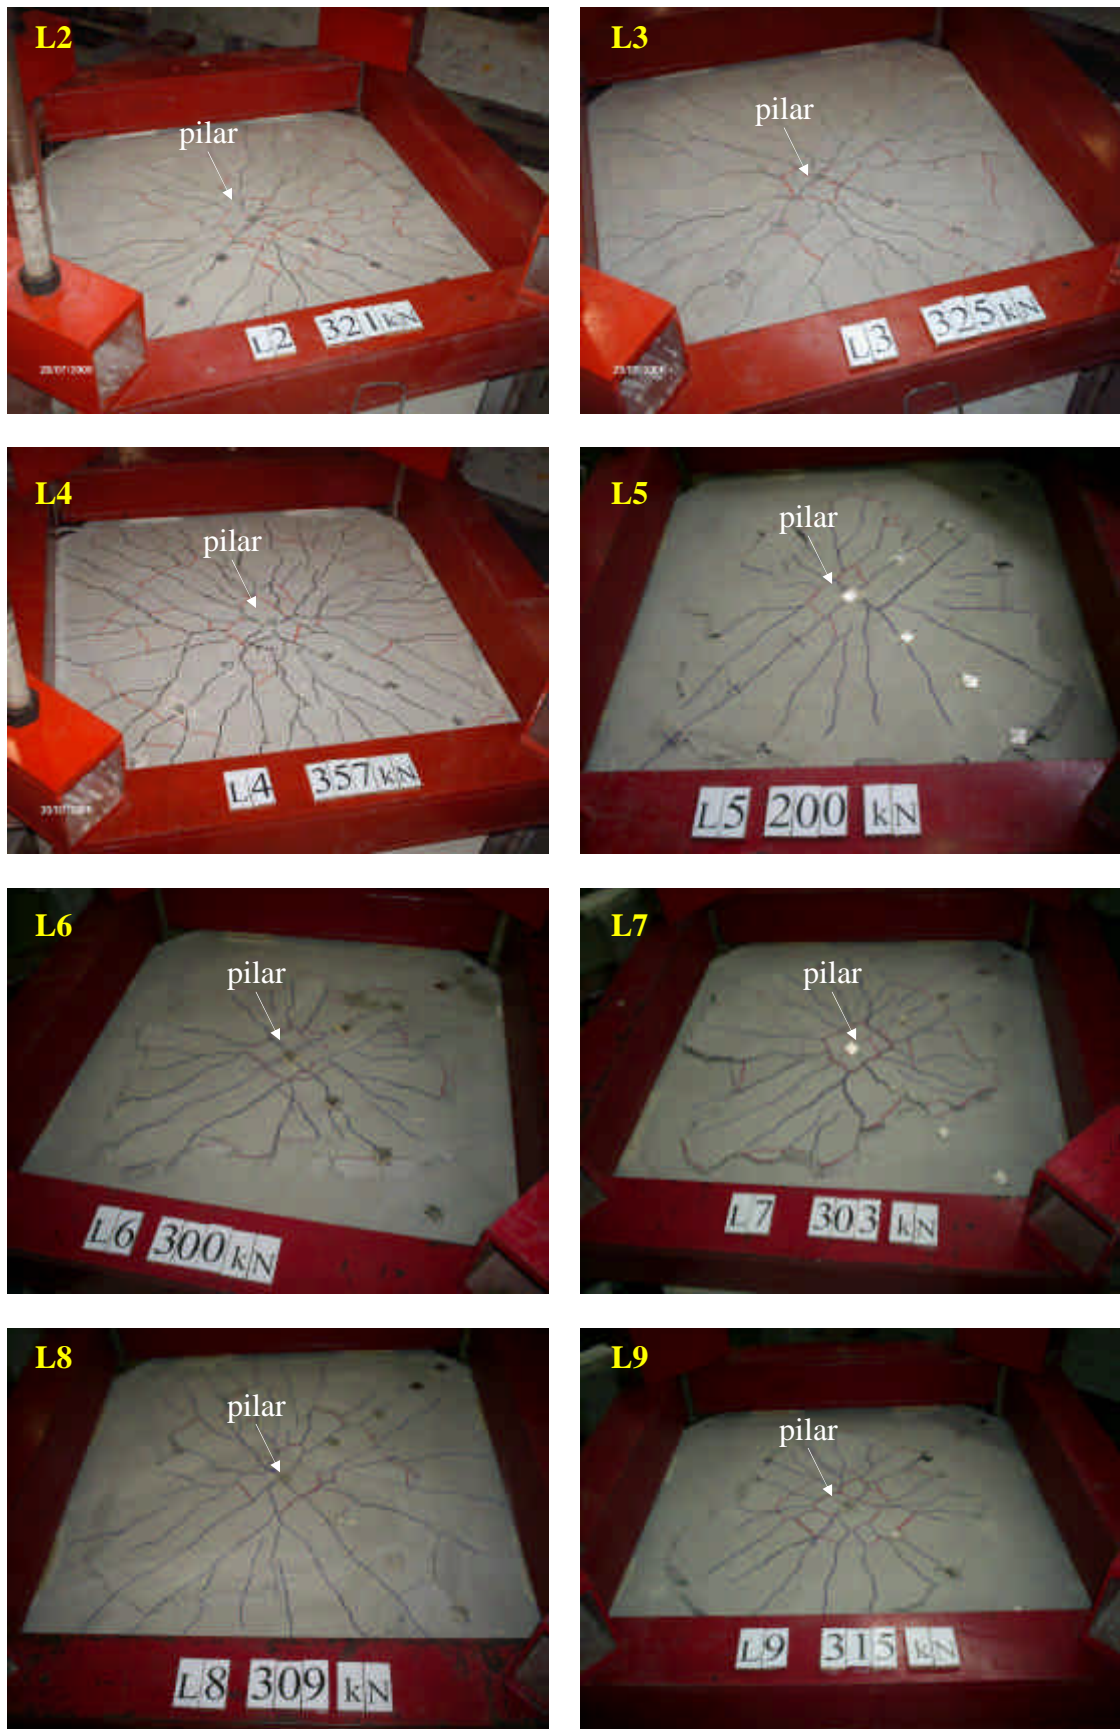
Fissuração, após a ruptura, das lajes com armadura de cisalhamento
